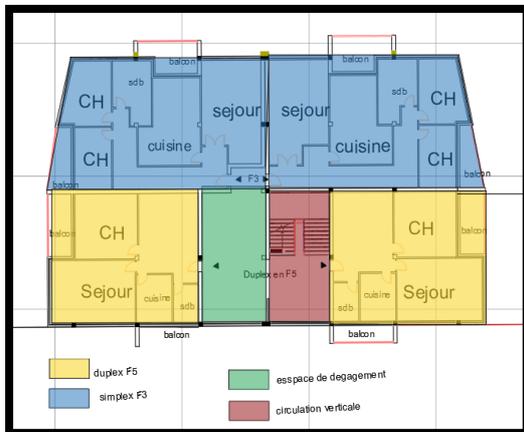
plan de 5eme au 12eme étage (Source : auteur).
